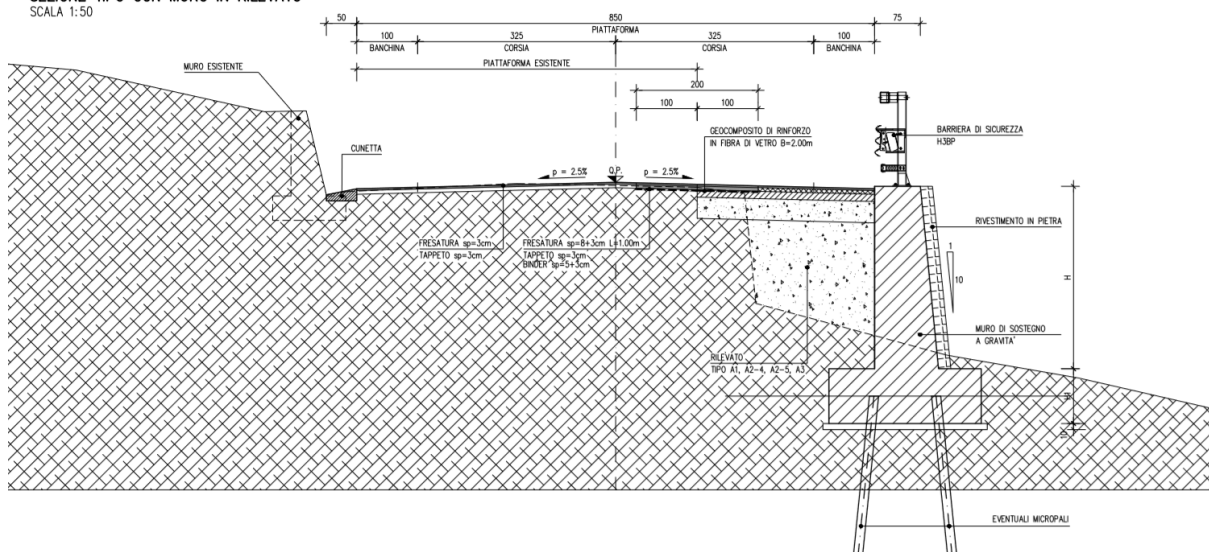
Sezione tipo in allargamento con muro di sostegno
